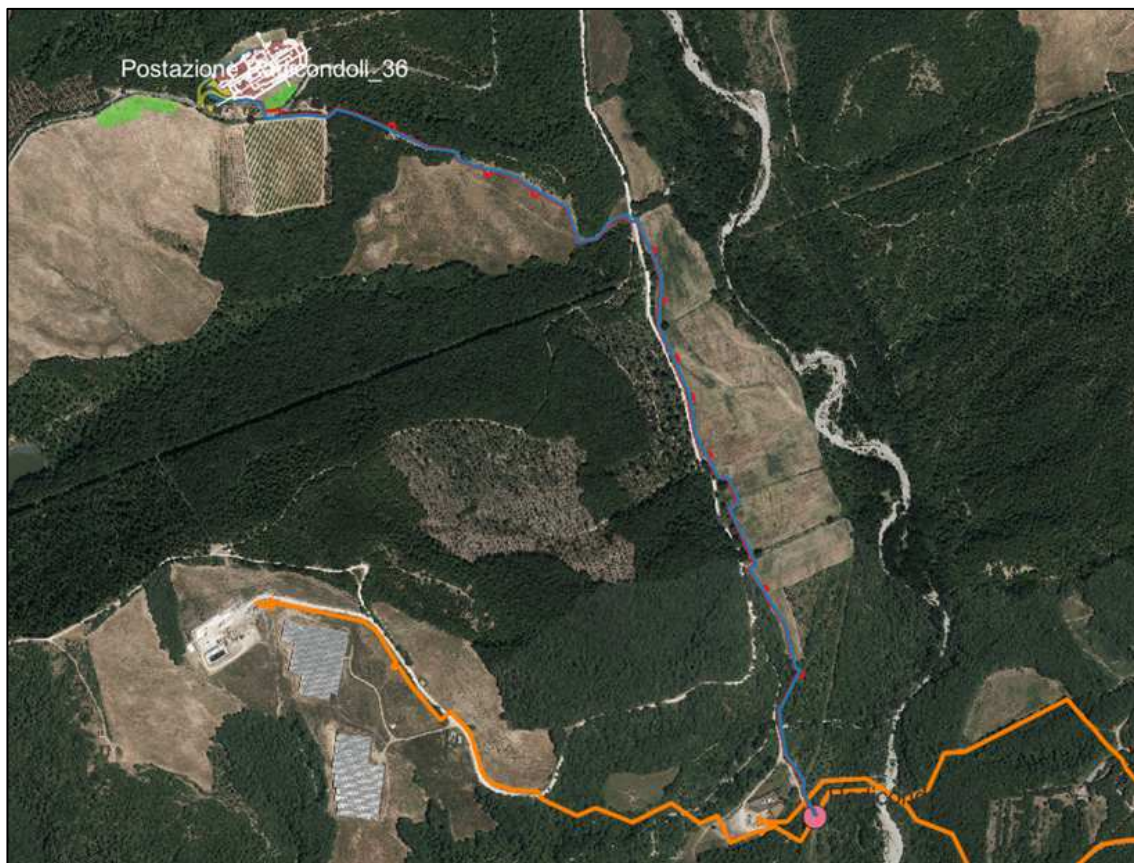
Planimetria dell'impianto con gli allacciamenti della rete fluidi. In rosso il nuovo tratto di vaporedotto/bifasedotto; in blu nuovo tratto di acquedotto.
